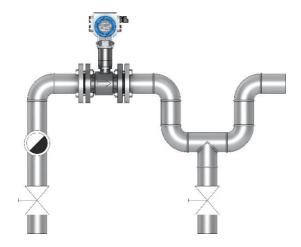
Монтаж расходомера в газо- или паропровод
